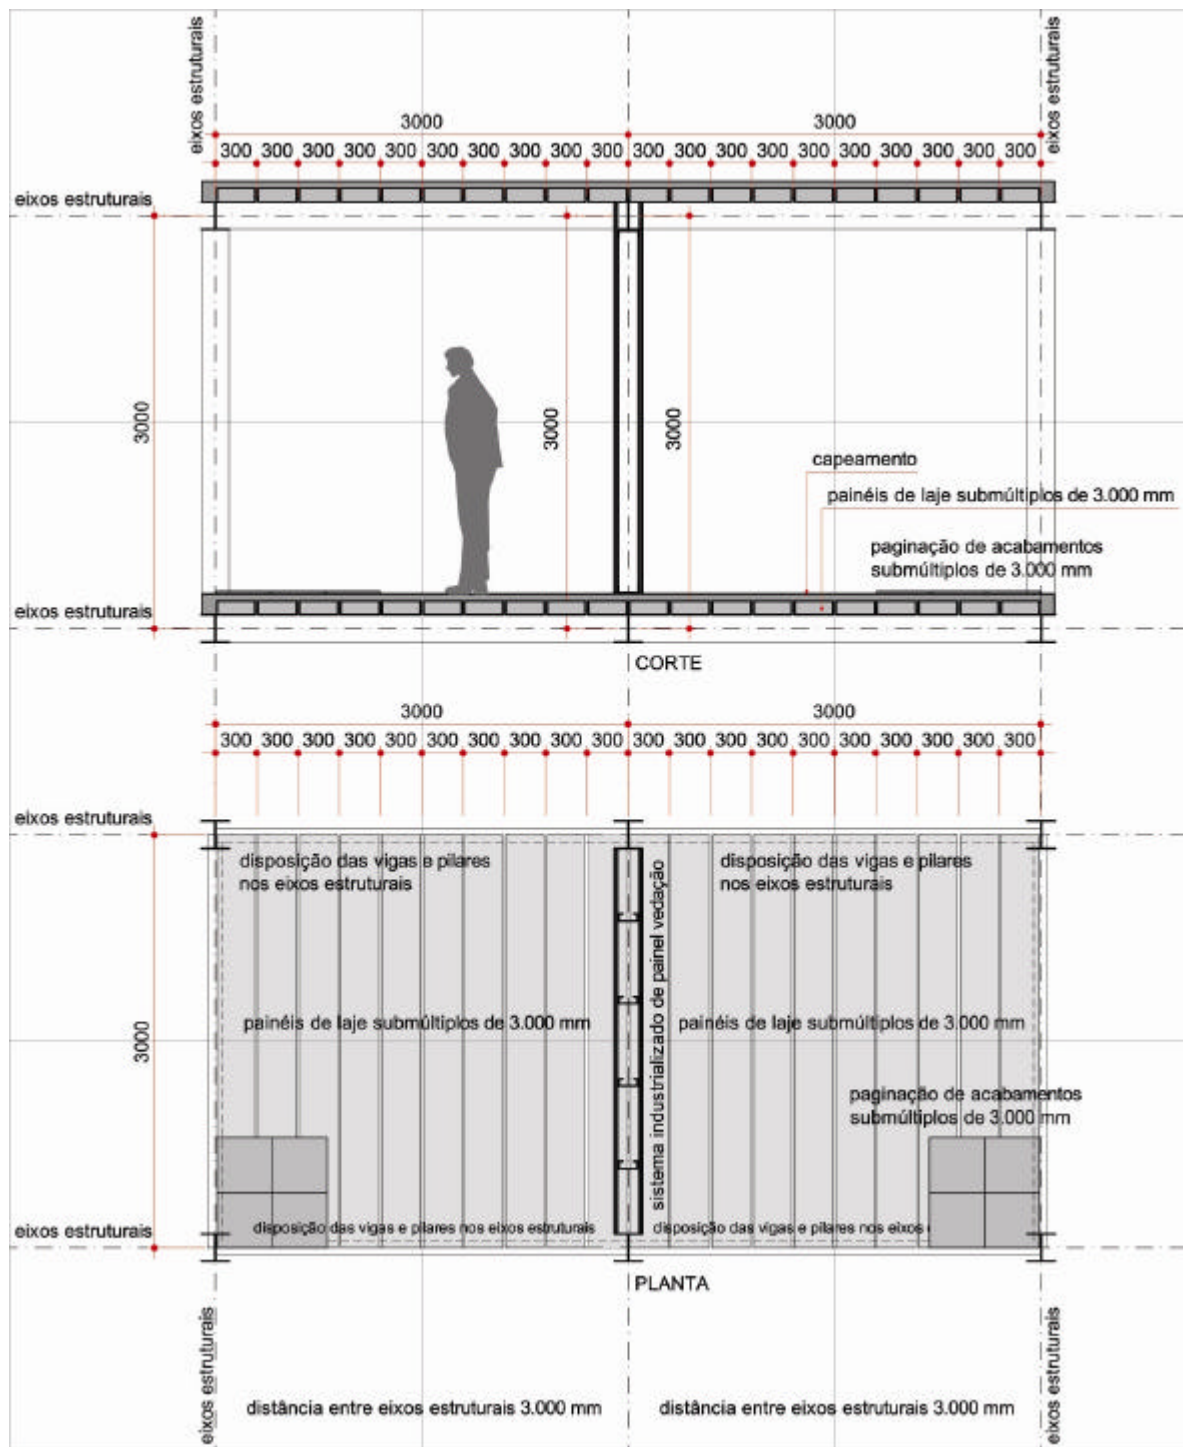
Coordenação modular entre estrutura, sistemas de lajes, sistemas de vedações e acabamentos. Planta e corte de um módulo típico – 3x3x3 m, com vedações divisórias internas.
